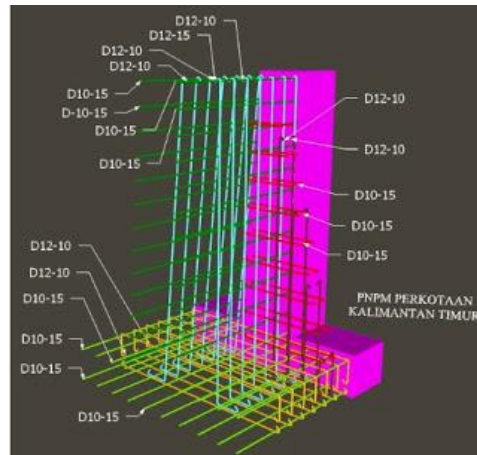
Dinding Penahan Tanah Type Cantilever (*cantilever retaining wall*)
